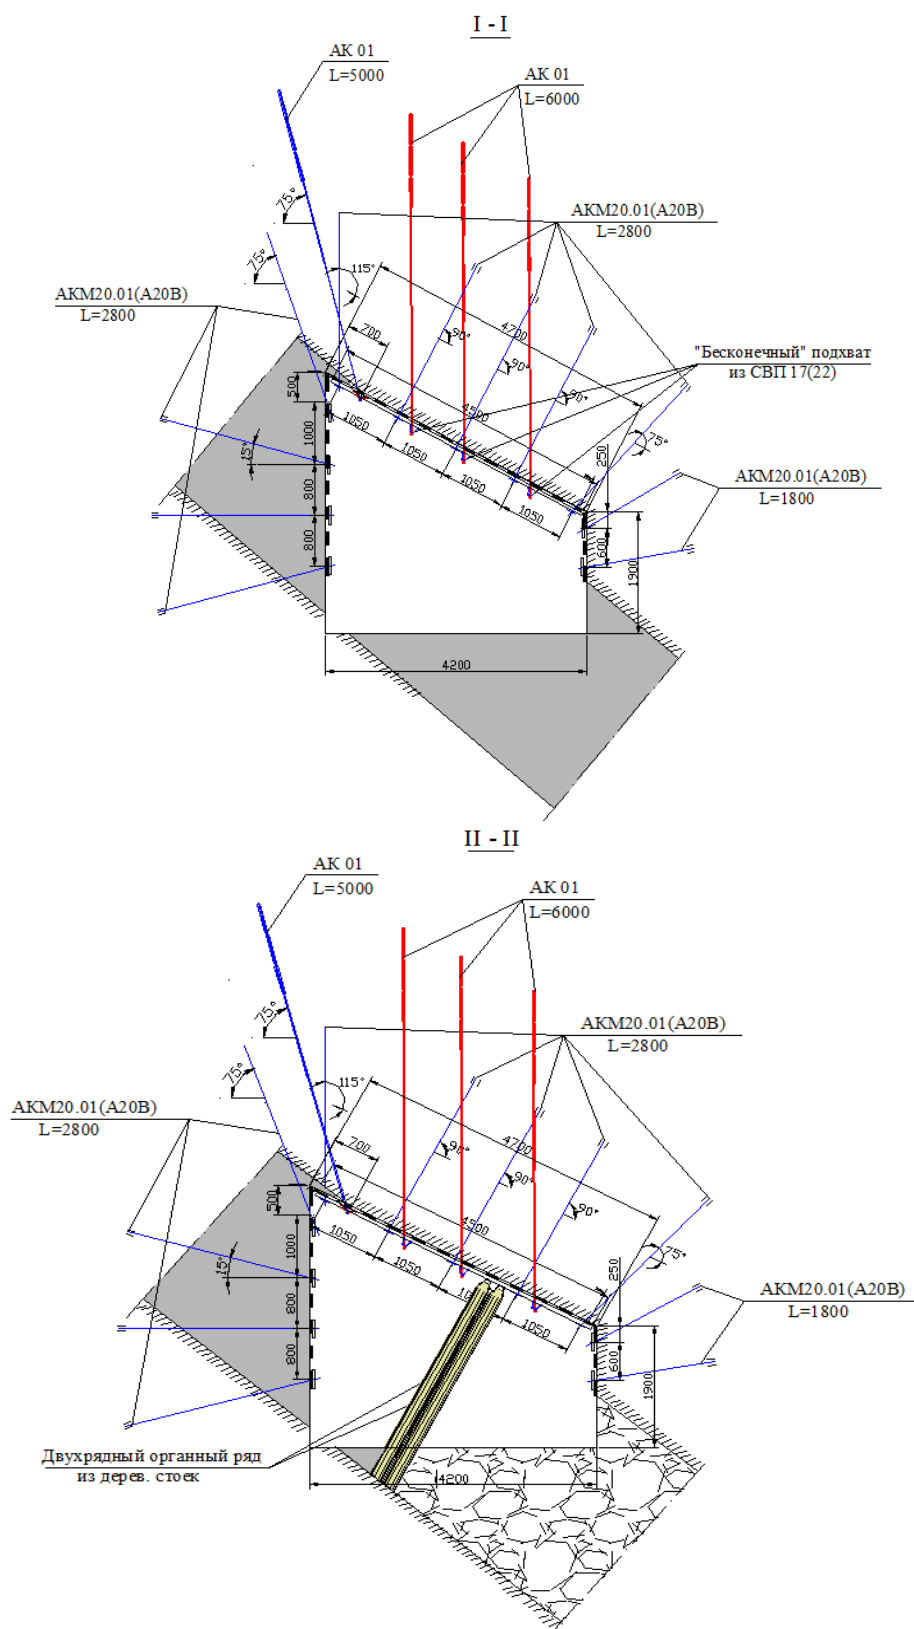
Схема усиления крепления вентиляционного штрека № 362
